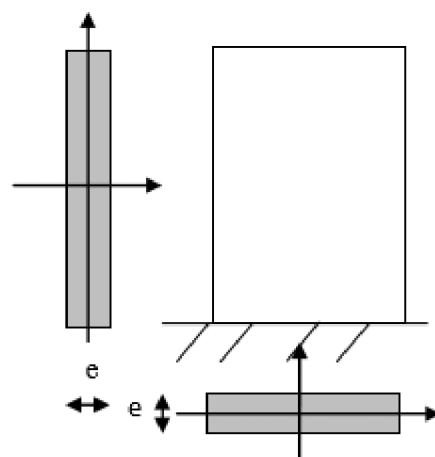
Vue en plan et en coupe des refends.
